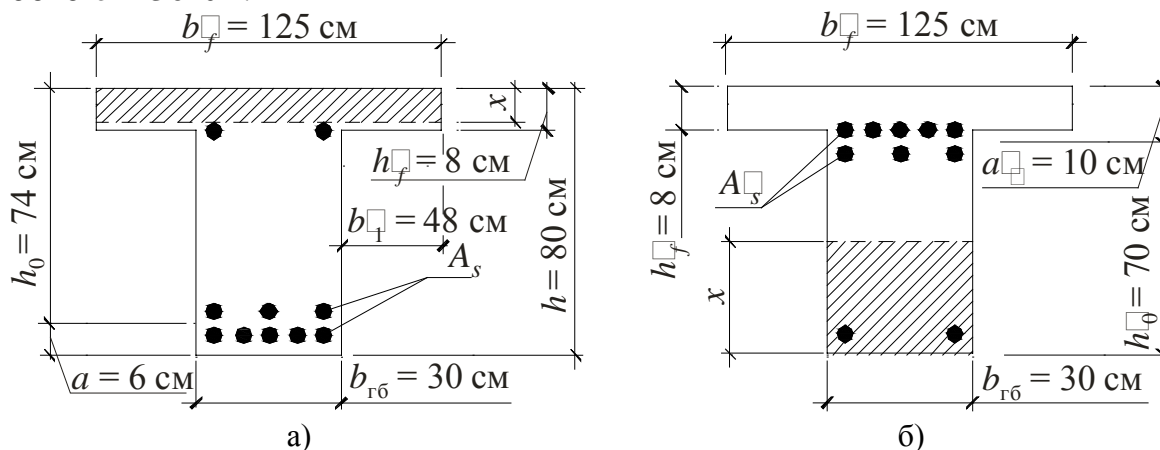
Розрахункові перерізи головної балки (перший проліт):
